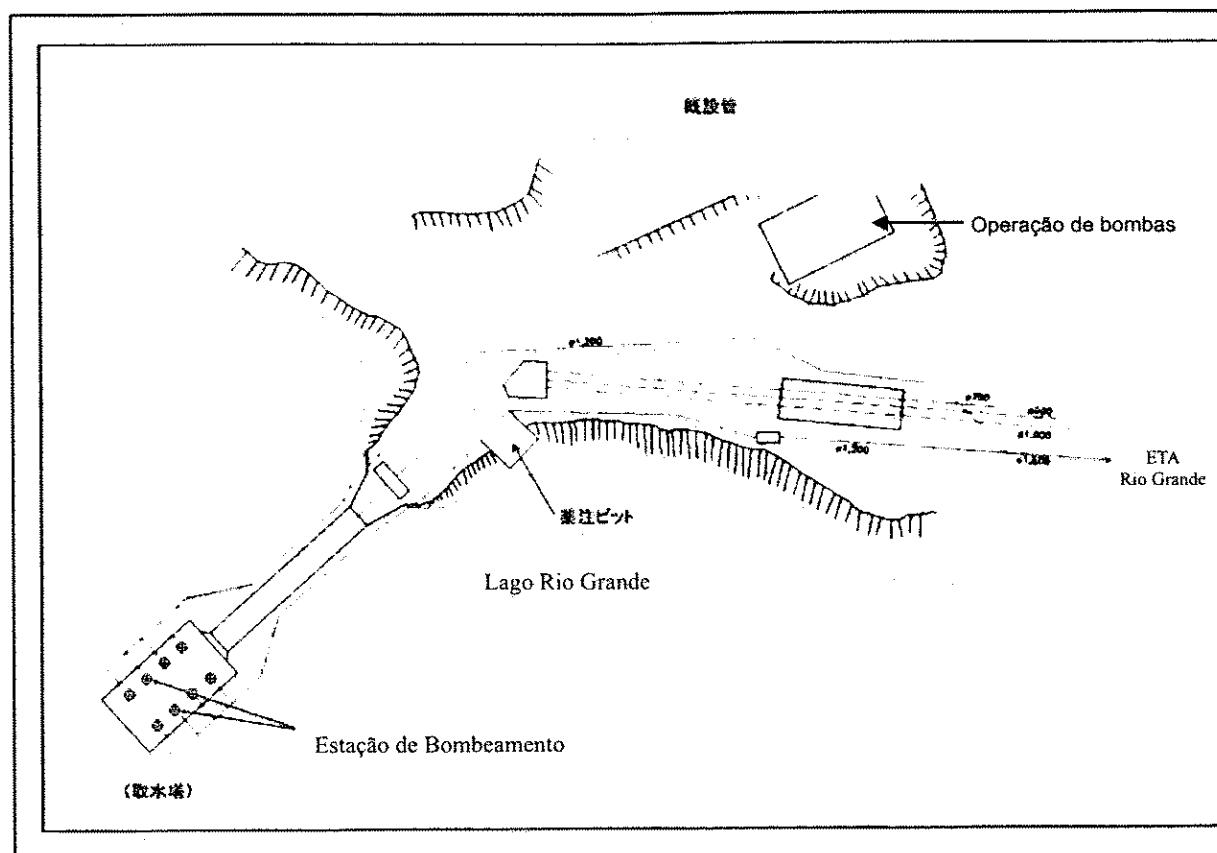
Estação de Bombeamento Rio Grande – planta de tubulação
